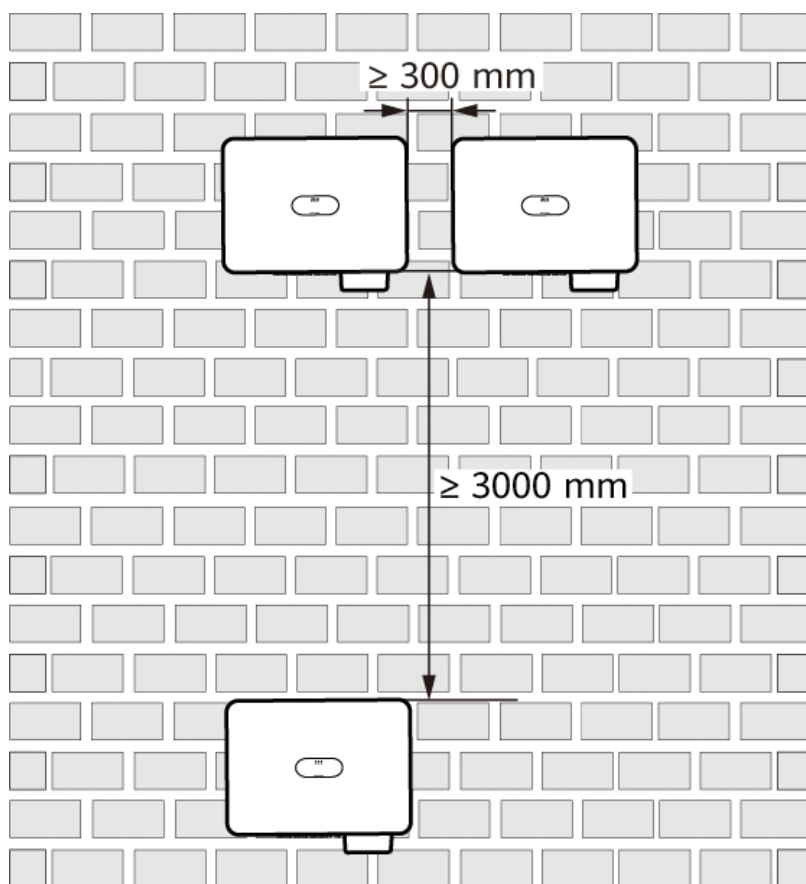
Dvouvrstvá instalace do trojúhelníku (nedoporučeno)
